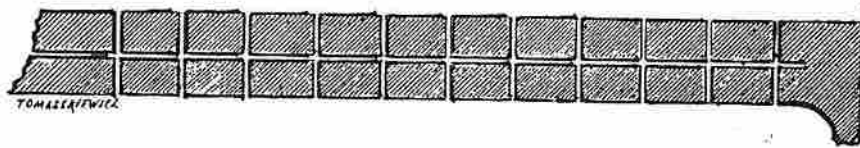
schéma des canaux de la maçonnerie du môle, A. Daux, 1868, planche n° VII, hors texte.
